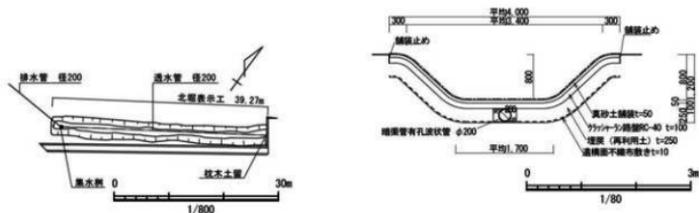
北堀平面図(左)と北堀標準断面図(右)
